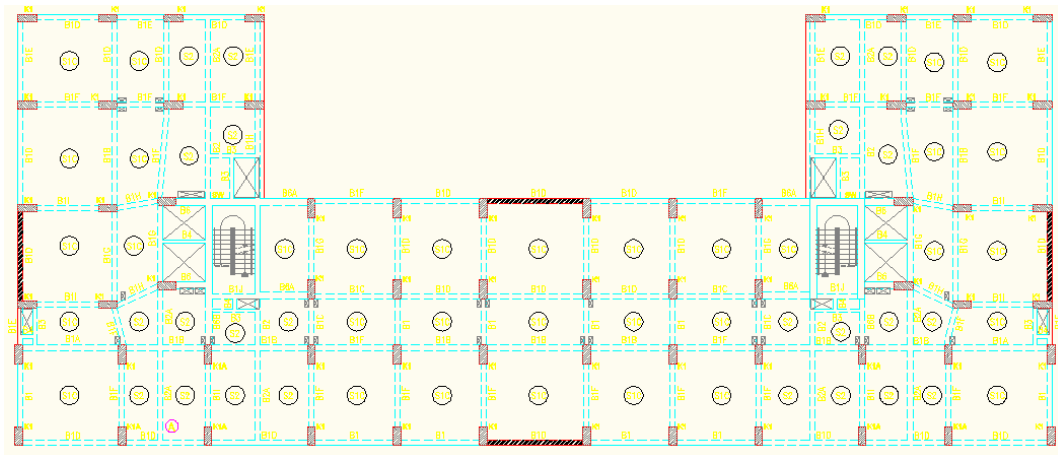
Model struktur bangunan gedung M-Square Apartment dengan dinding geser (tipe III) pada SAP 2000 v.14
